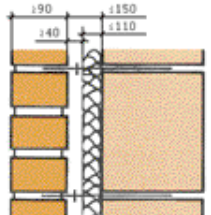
Двухслойная облицовочная кладка с воздушной прослойкой и теплоизоляцией
